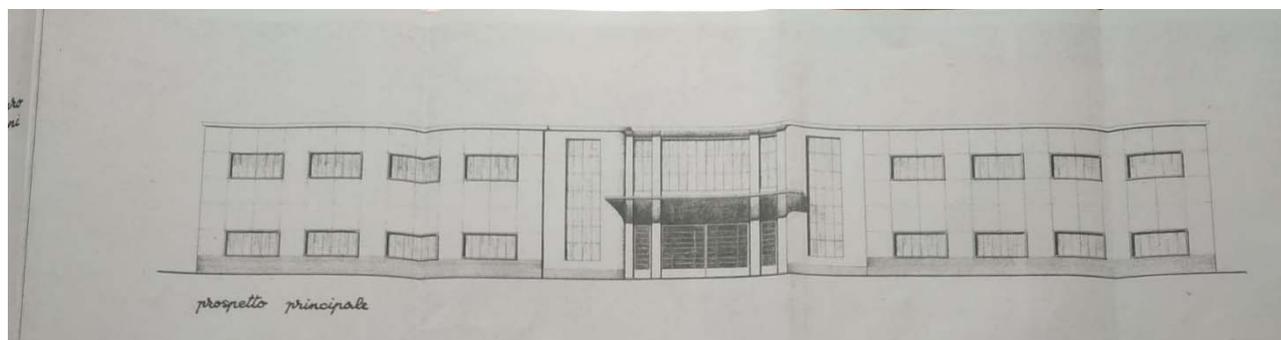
progetto di costruzione dello stabilimento Tipo litografico “Emilio Di Mauro” a Cava de Tirreni, febbraio 1948
